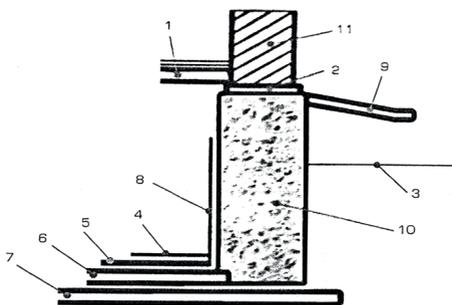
Устройство гидроизоляции с использованием цемента «Гидро-5»:
